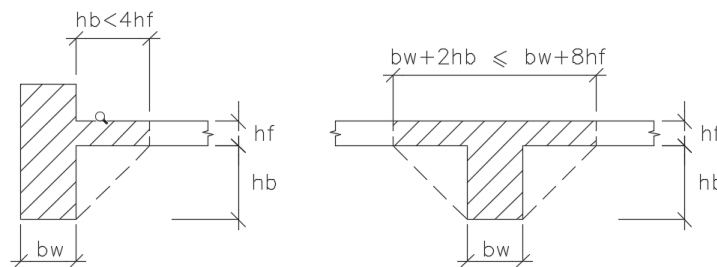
Porciones de la losa que deben incluirse en la viga
